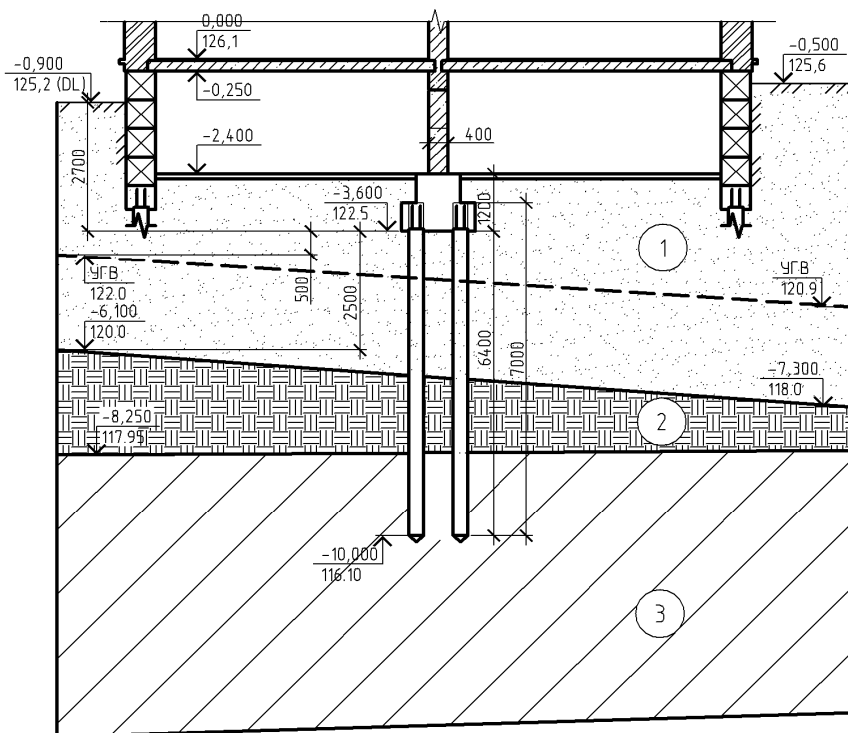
Схема к предварительному выбору свайного фундамента под колонну
